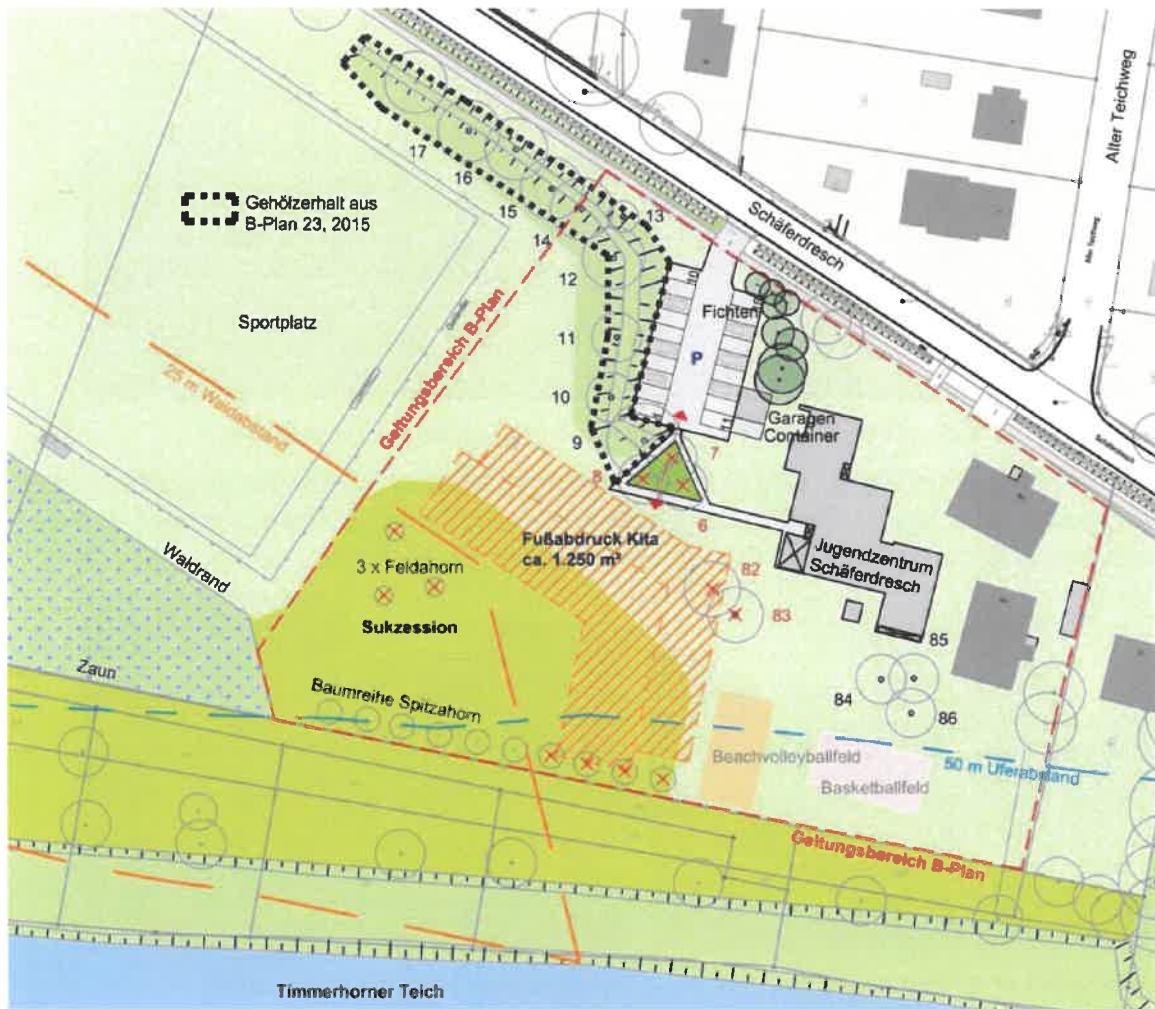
Baumbestand mit Überlagerung der KiTa-Planung
